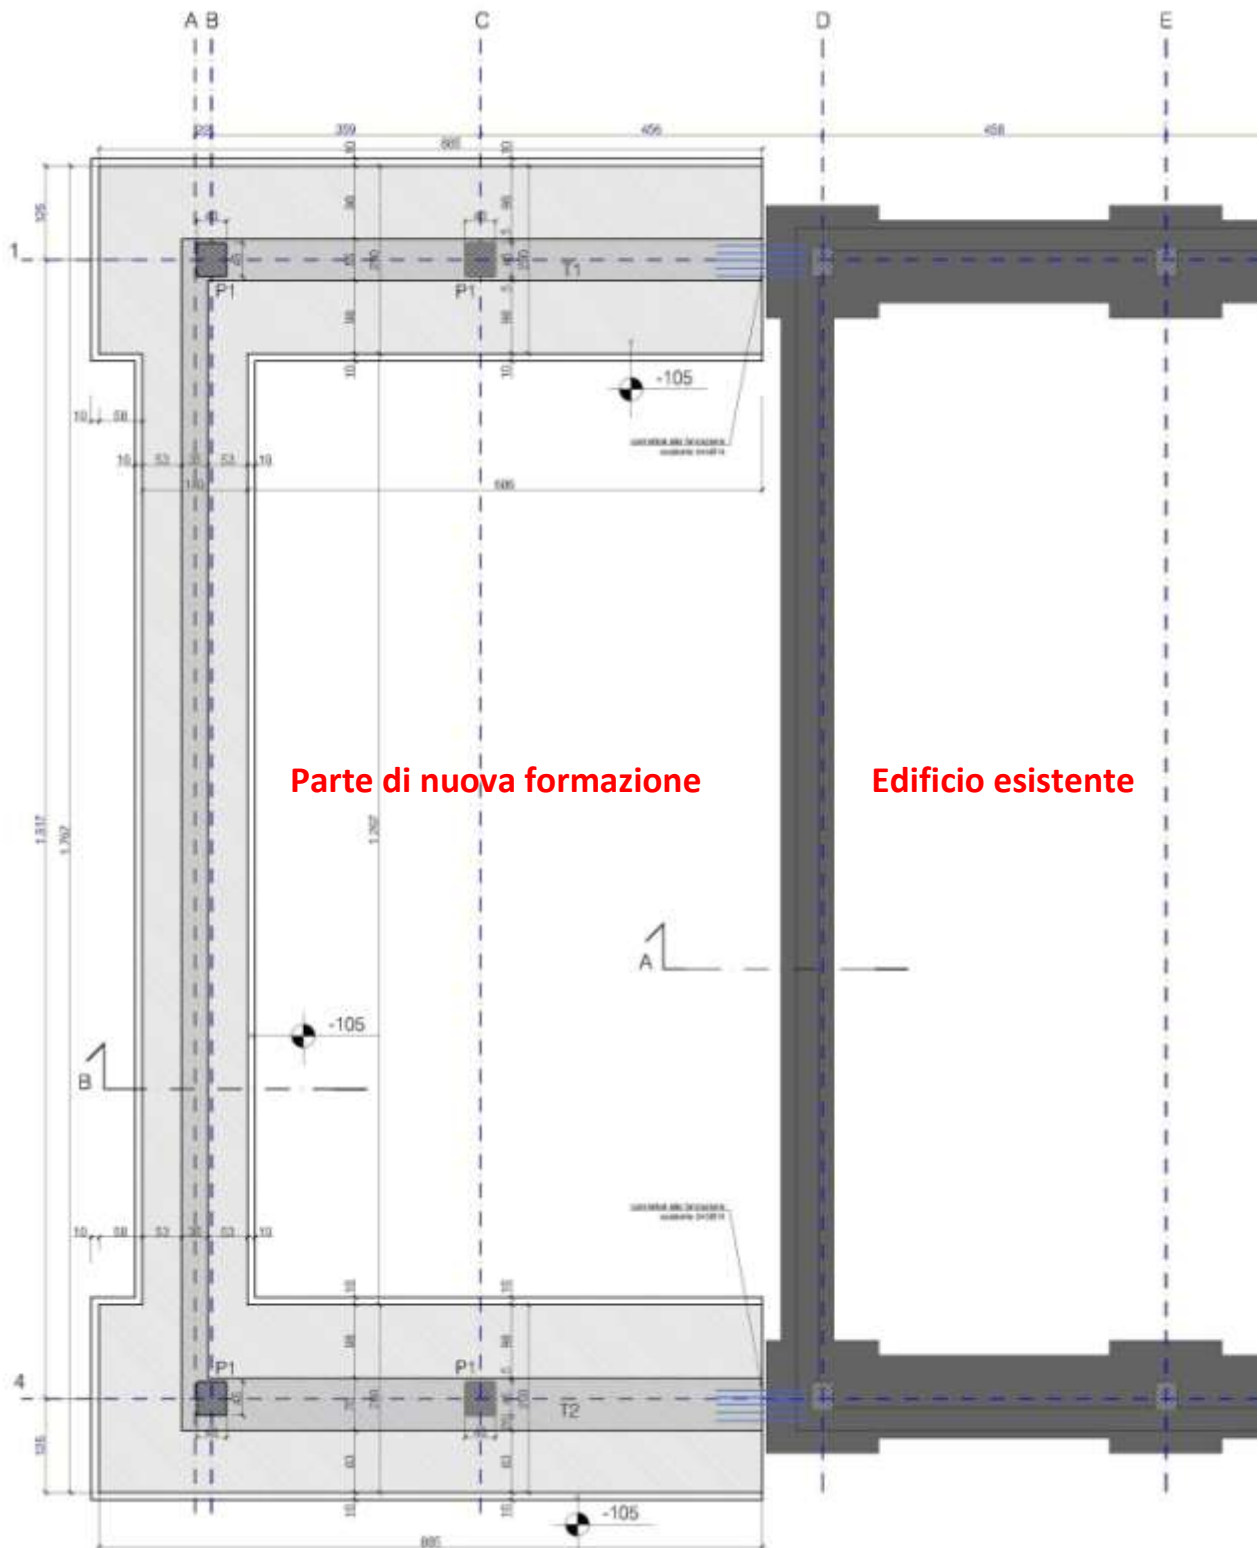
Stralcio della pianta delle fondazioni (tavola S01).
